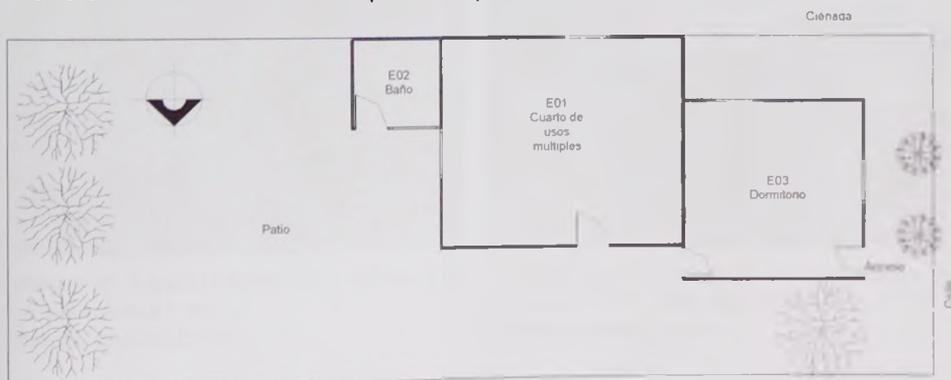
Materiales de construcción de una vivienda P tipo "b".
